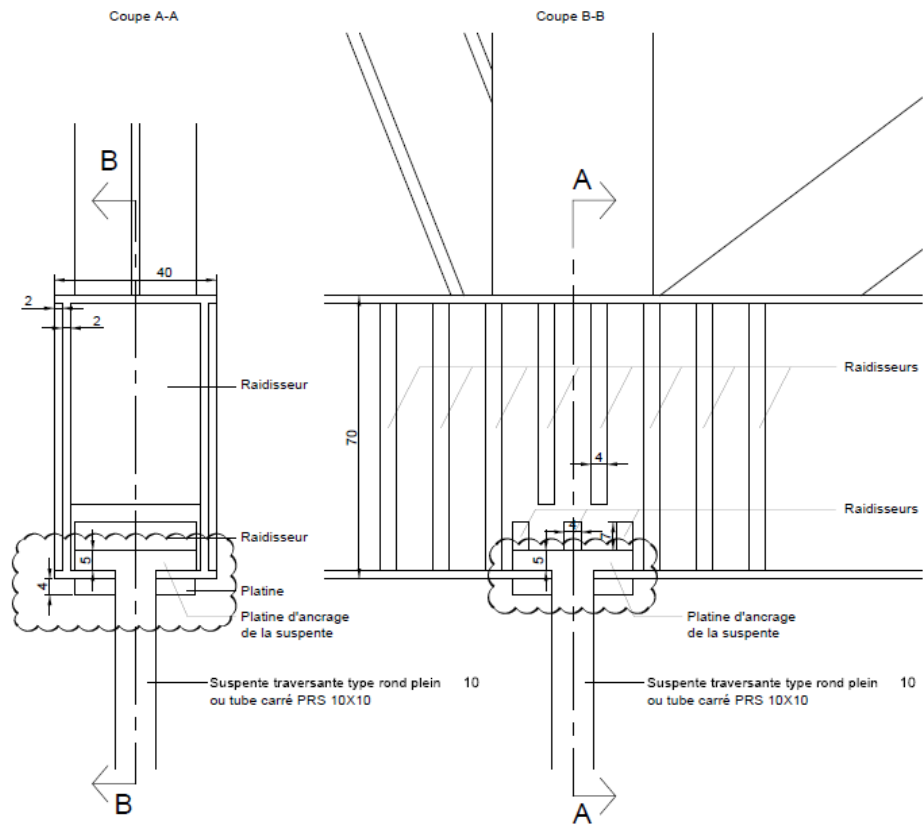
Détail d'assemblage avec la poutre treillis // © bordas+peiro
